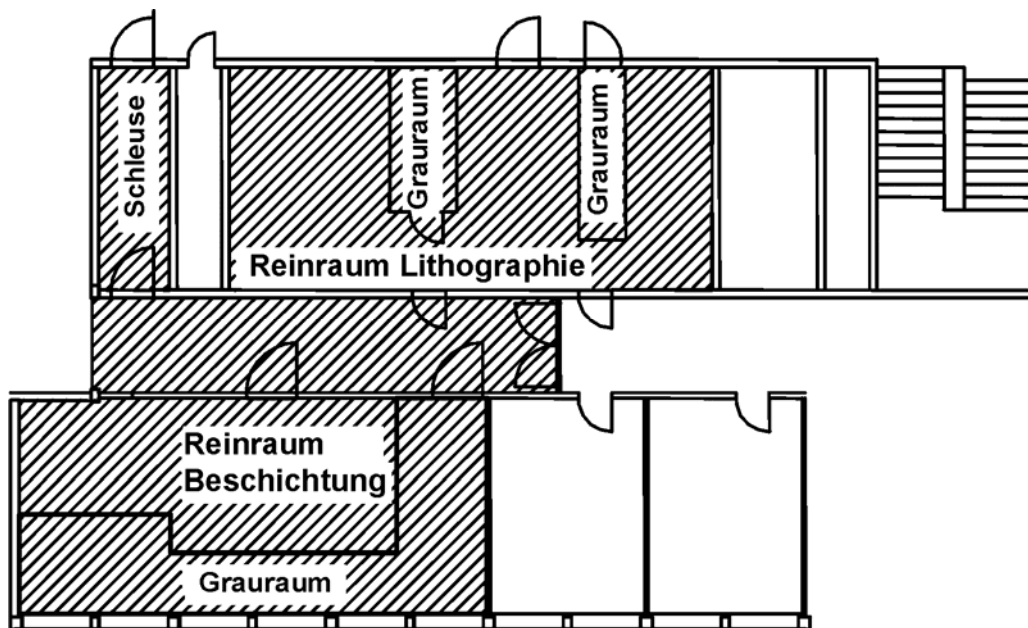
Reinraum-Labor für Mikrotechnik (Grundriss, schematisch)
